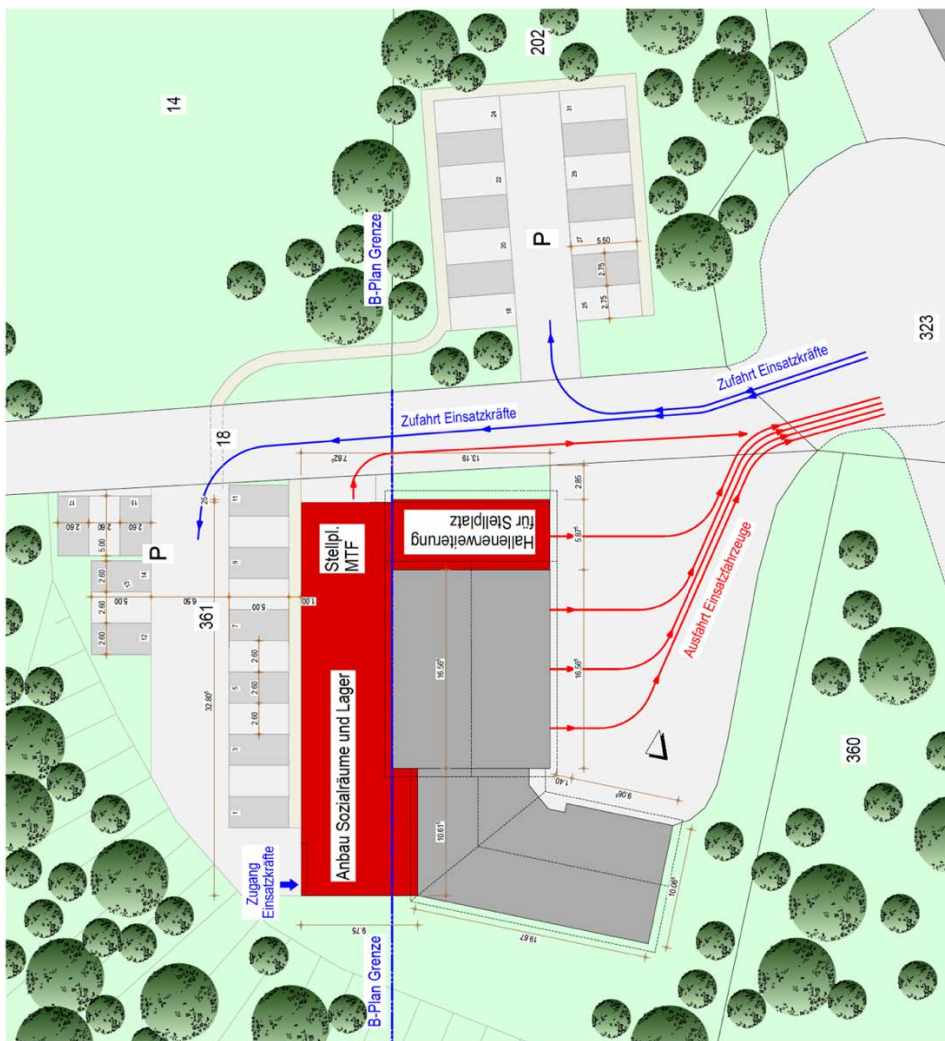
Lage- und Organisationsplan für den Anbau des Feuerwehrhauses (Quelle: Schneider Architekten)
